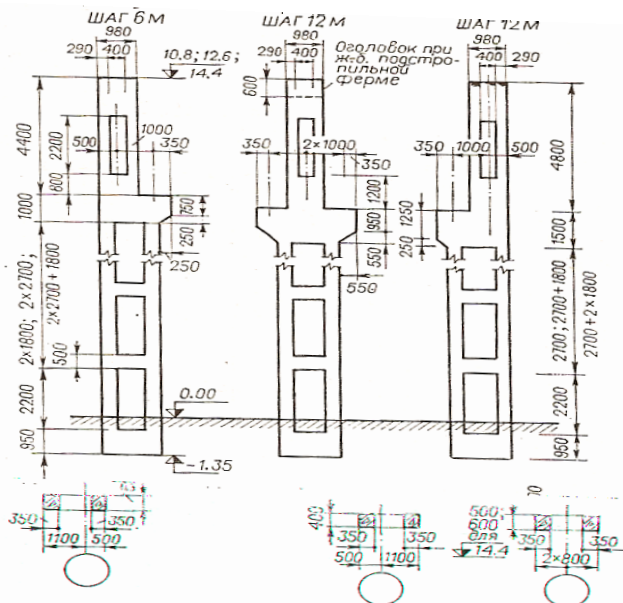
Двухветвевые железобетонные колонны с проходами в уровне крановых путей
